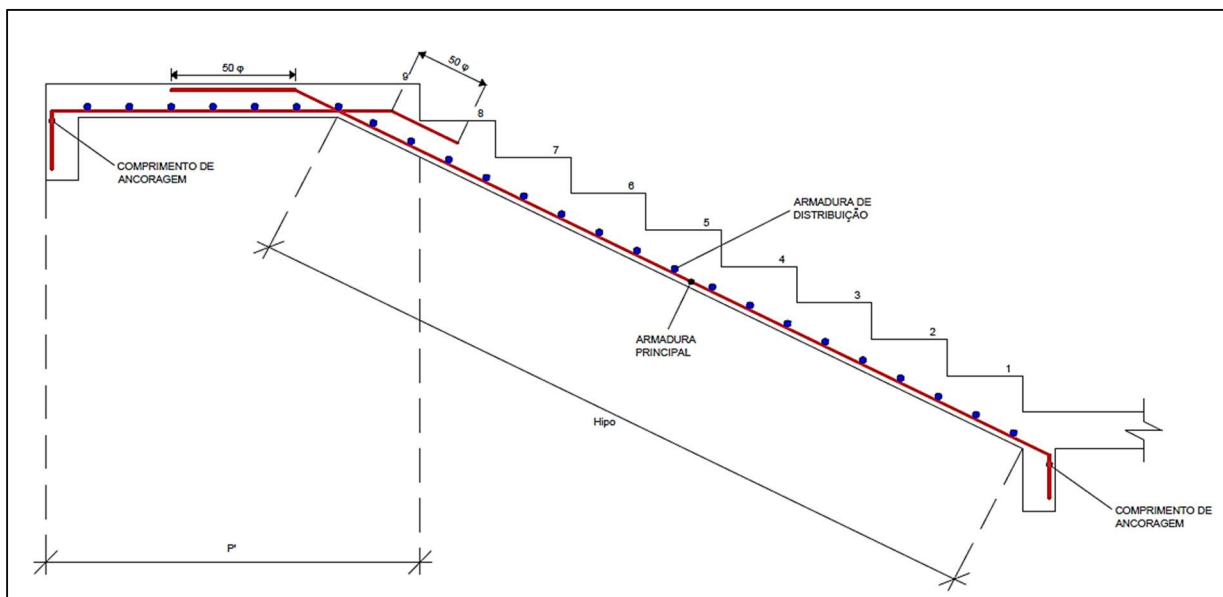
Armação da escada de concreto. (Fonte: Autor; 2023)
